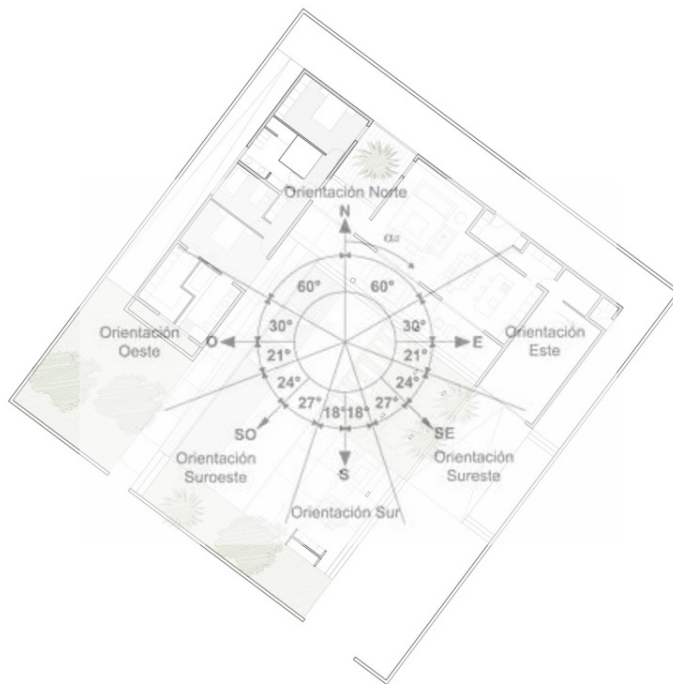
Ejemplo: orientación de las fachadas de una vivienda
